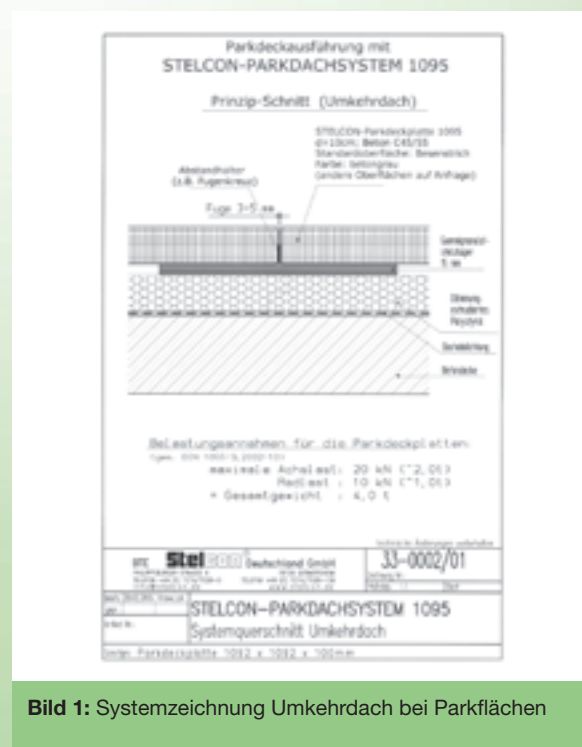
Systemzeichnung Umkehrdach bei Parkflächen
